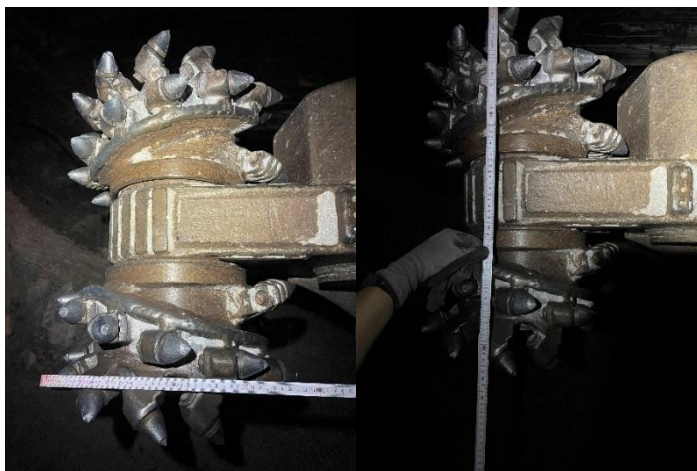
Dimensionen des Fräskopfes (Foto Autor)
